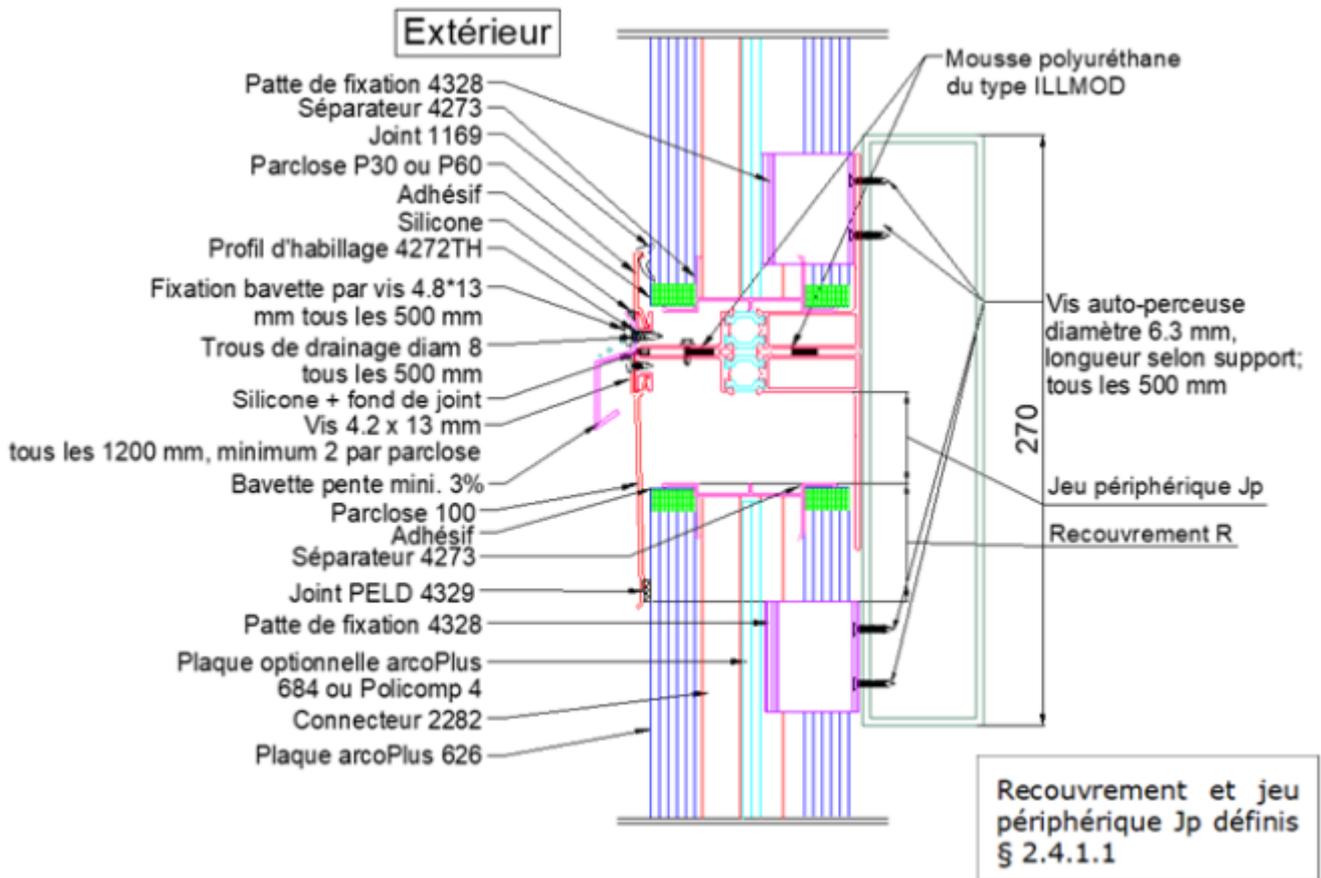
Raccord de hauteur n°2 - façade basse limitée à 10 mètres de haut
